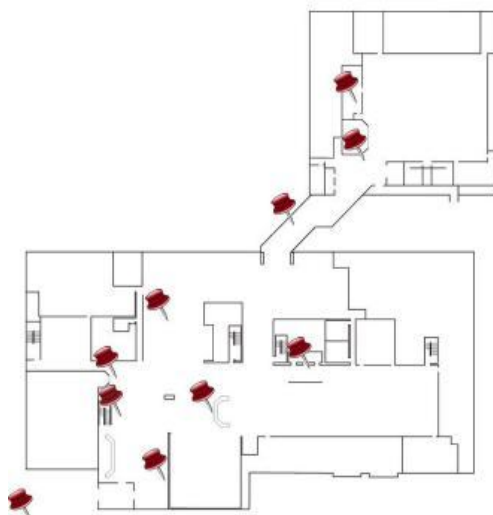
Grundriss der VBF Hawaii⁸⁵
